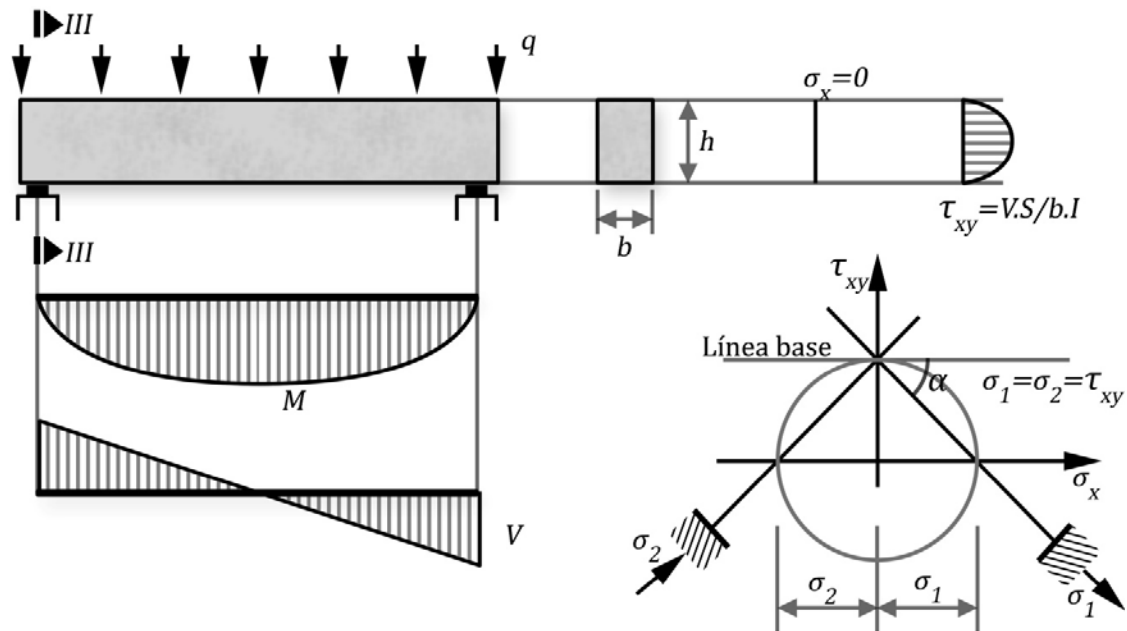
,6: Estado tensional en la sección extrema. Fisuras a cortante
